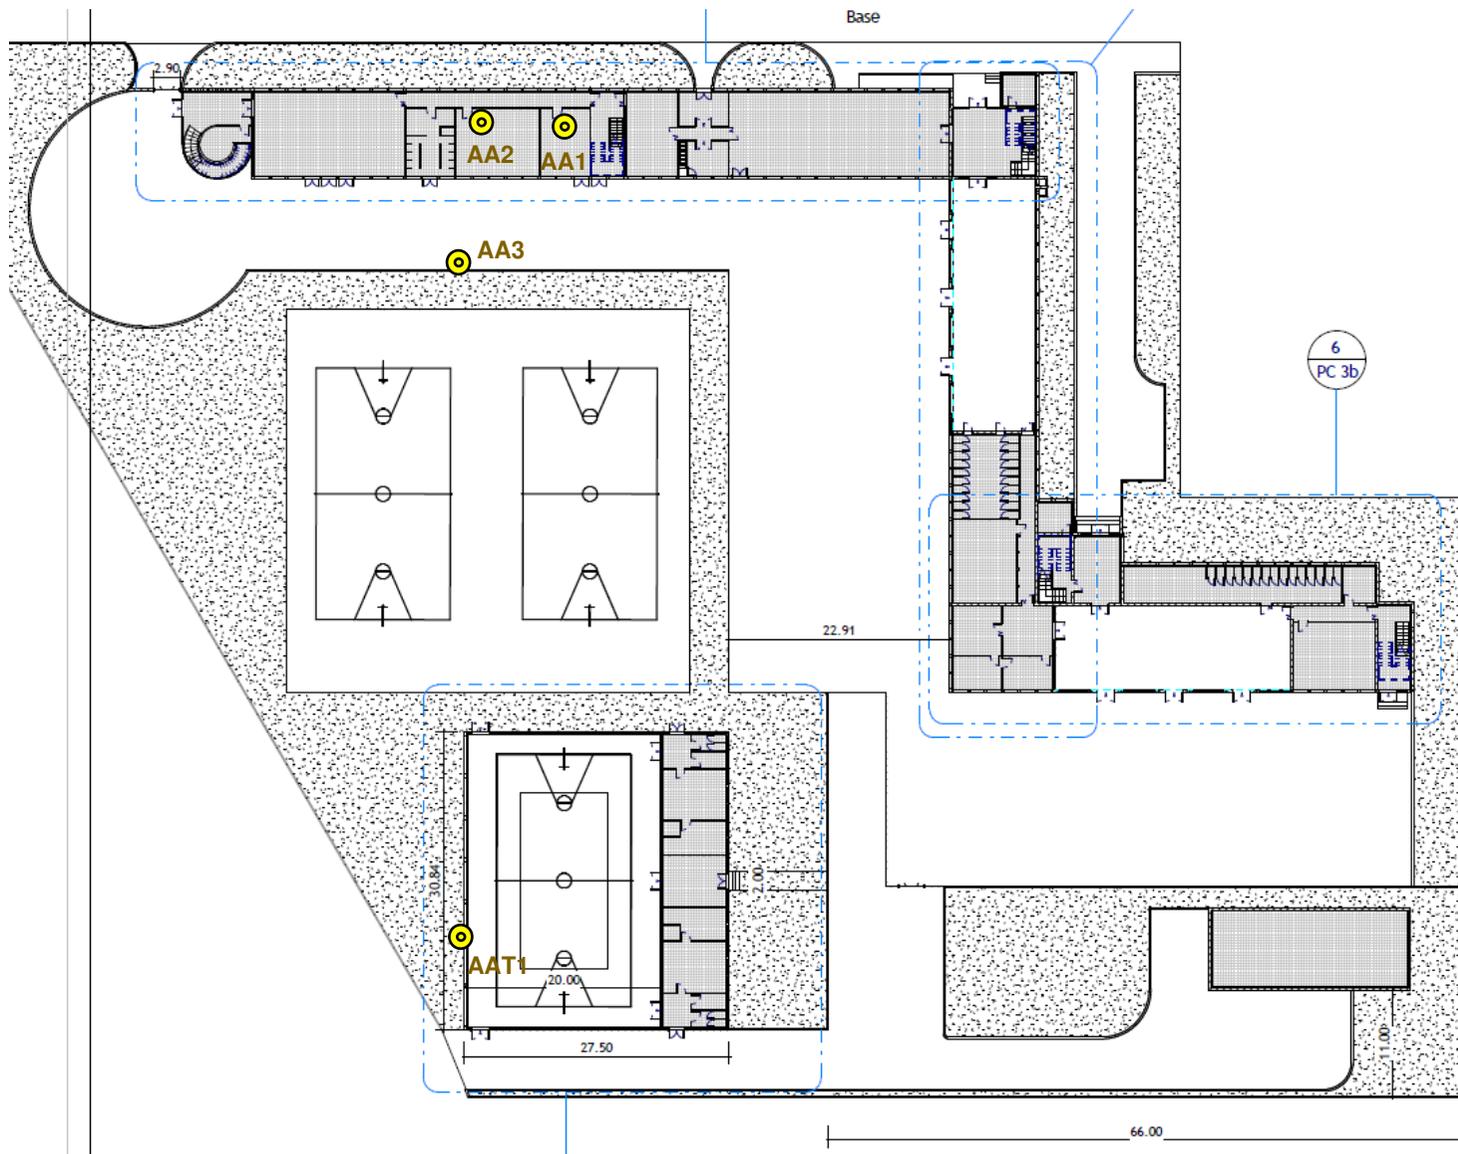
plan de localisation des prélèvements (fond de vue : plan école du client)
